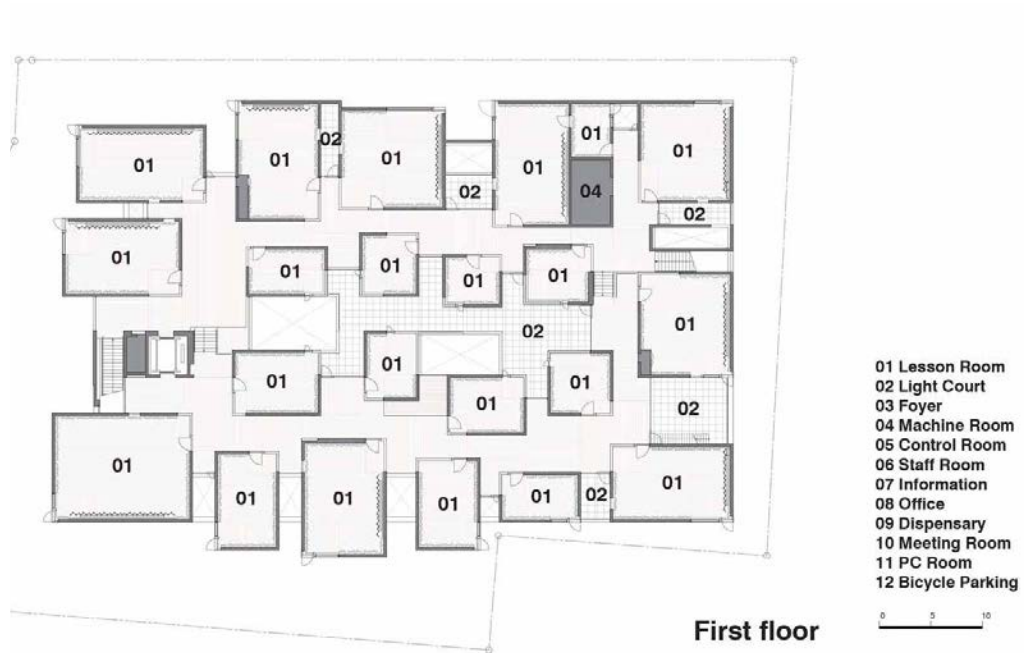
"Planta de las salas de estudio del Proyecto"
